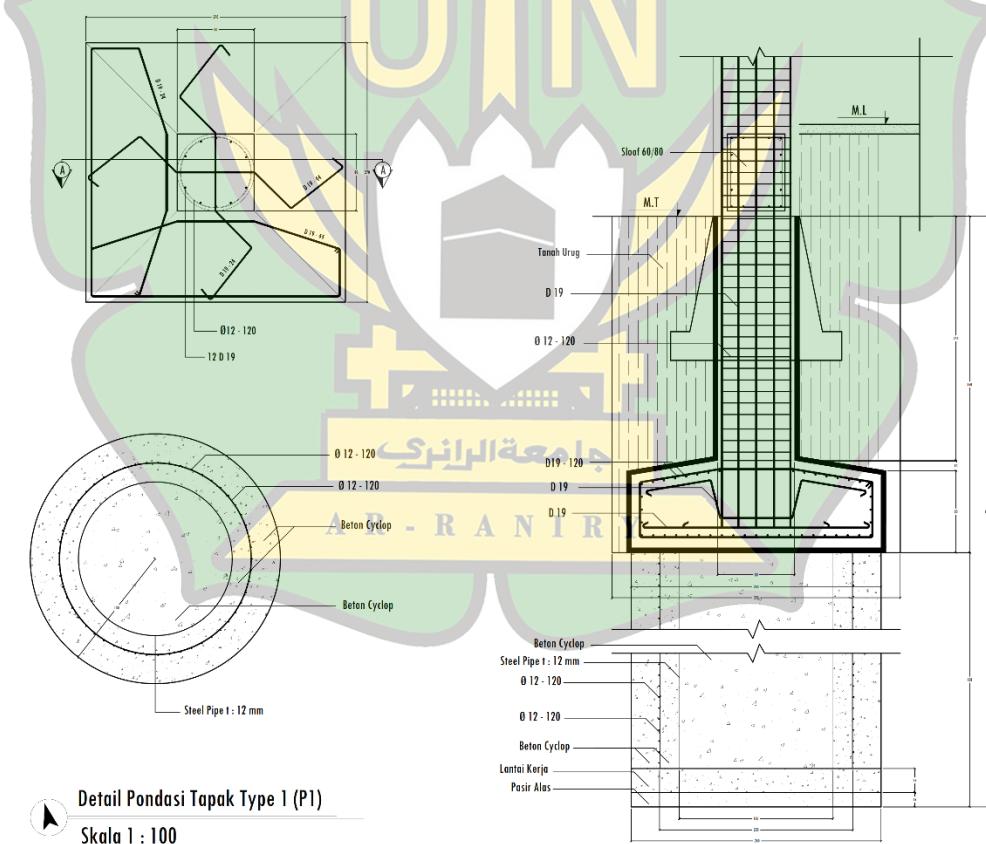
Rencana Pondasi Convention Hall
